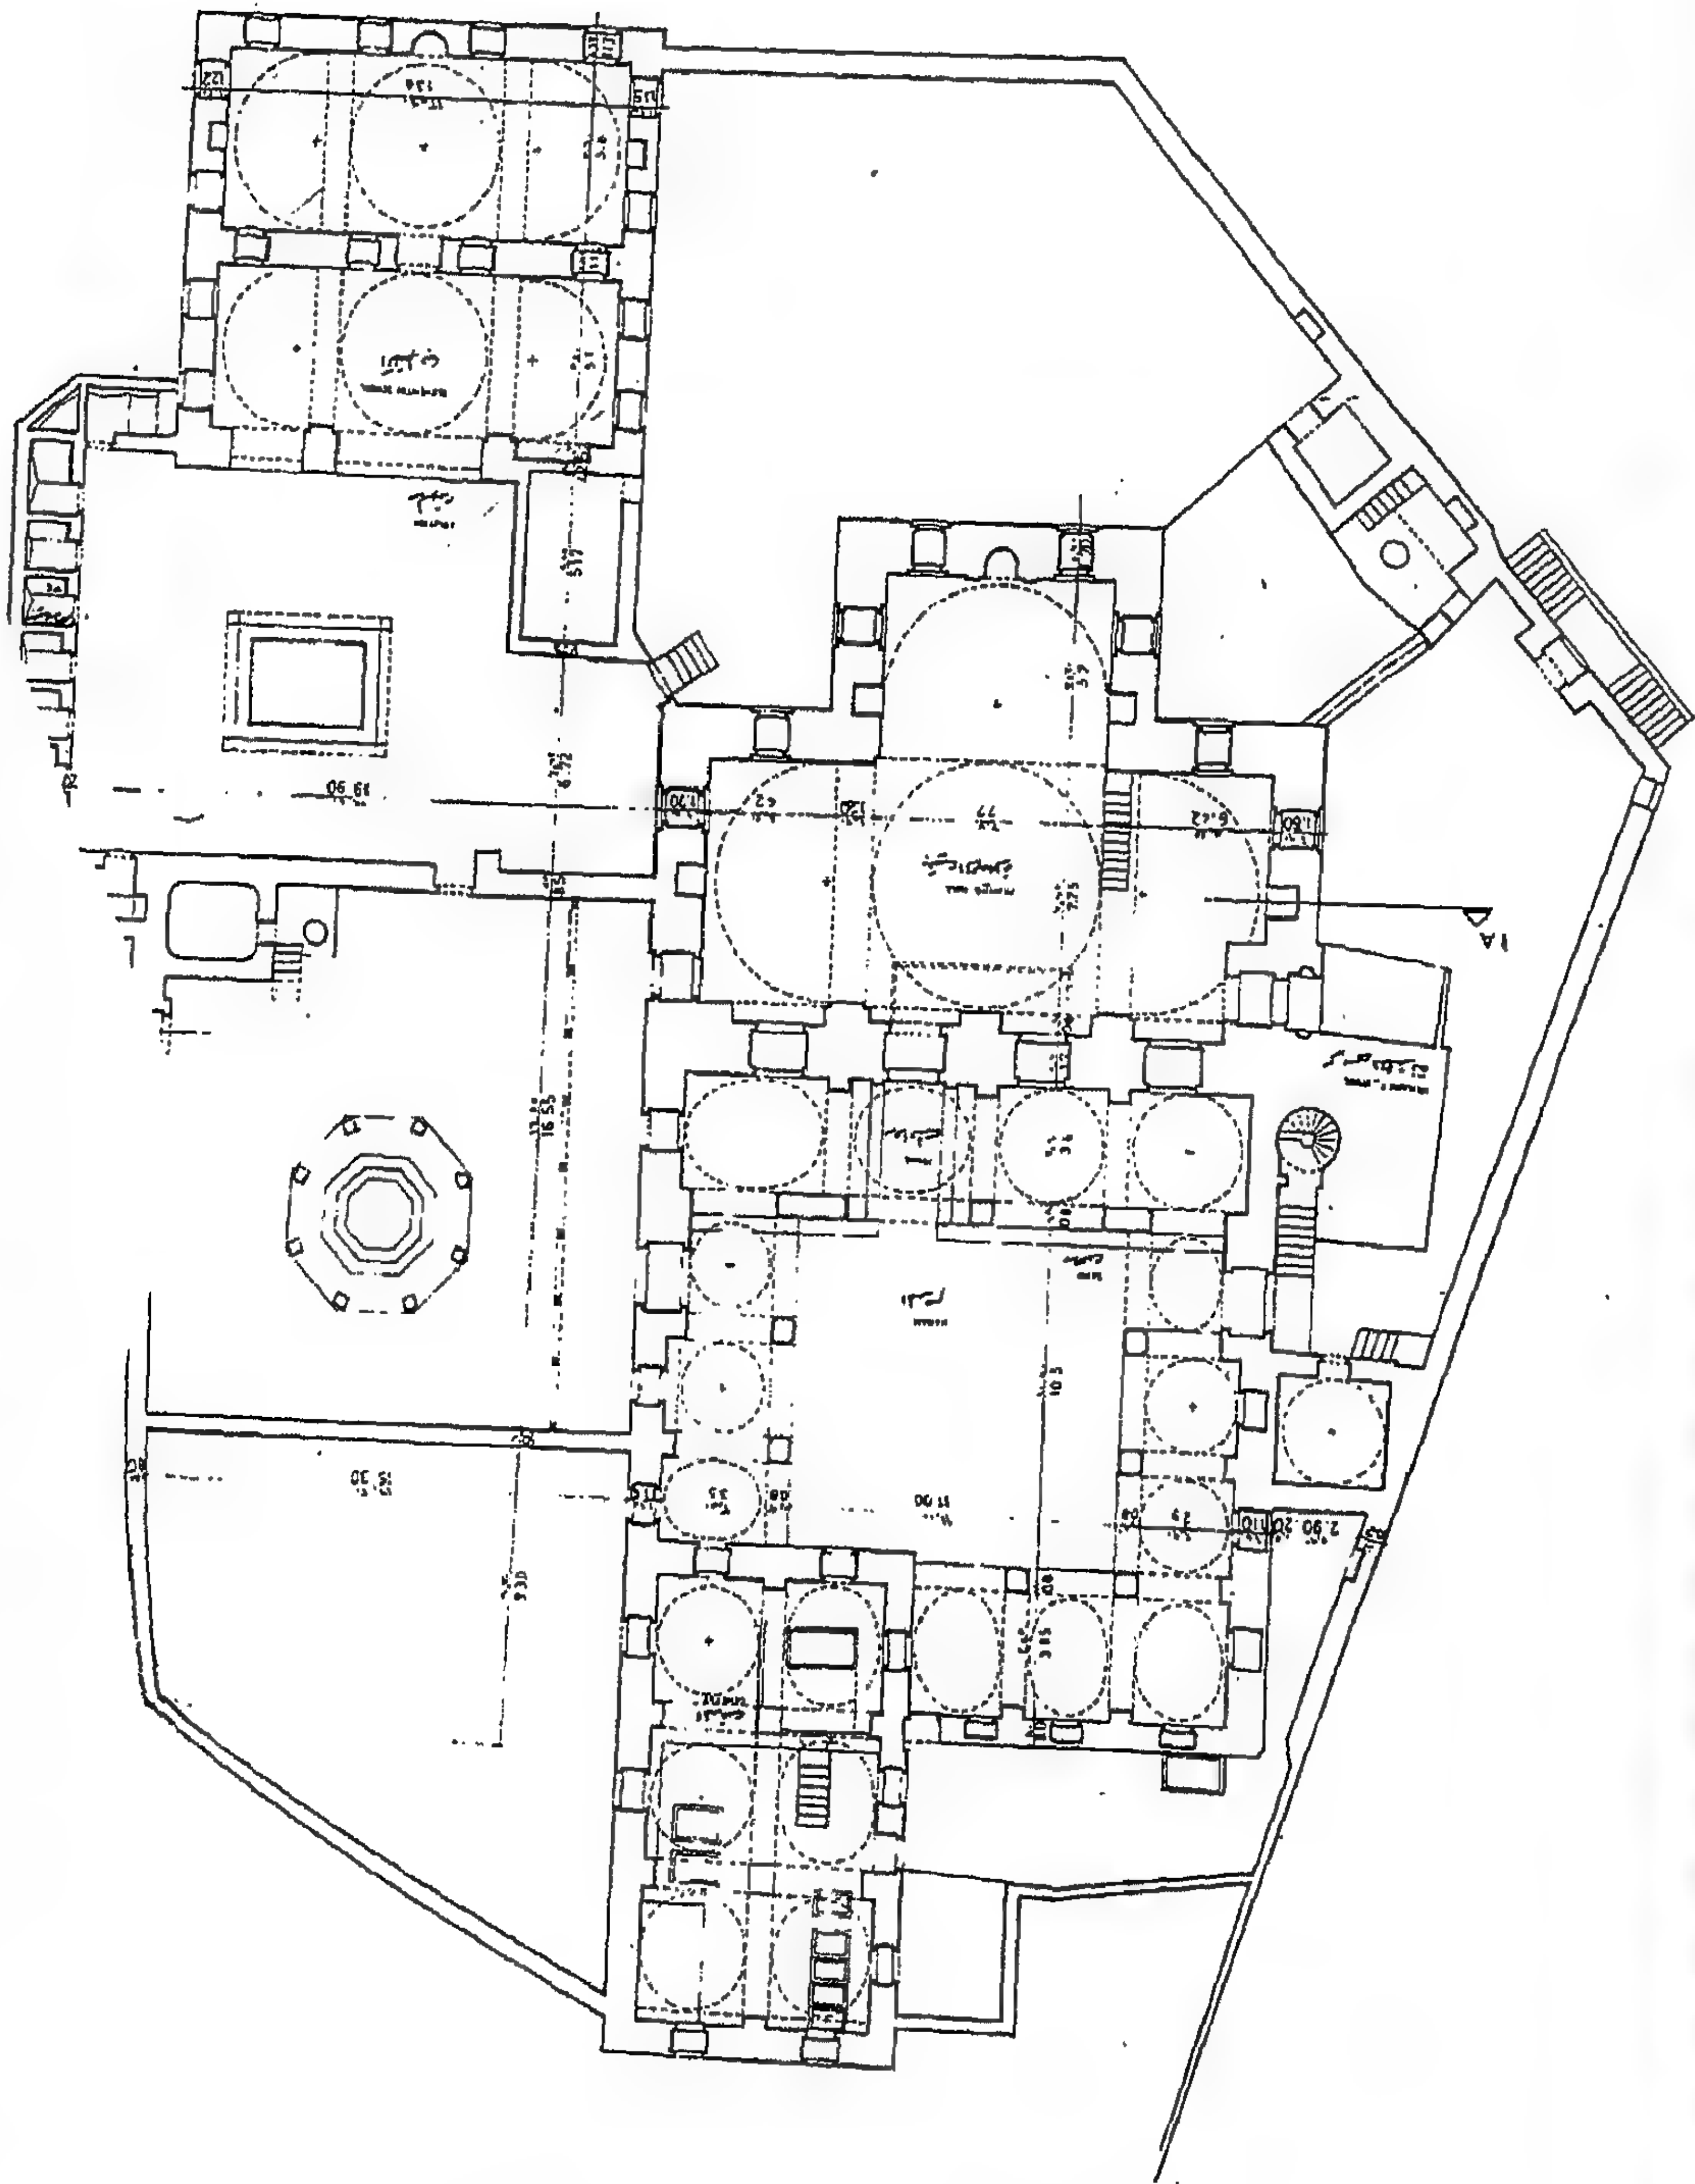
مسقط أفقي لجامع بيالة باشا بقاسم باشا في إسطنبول. (كوران)
